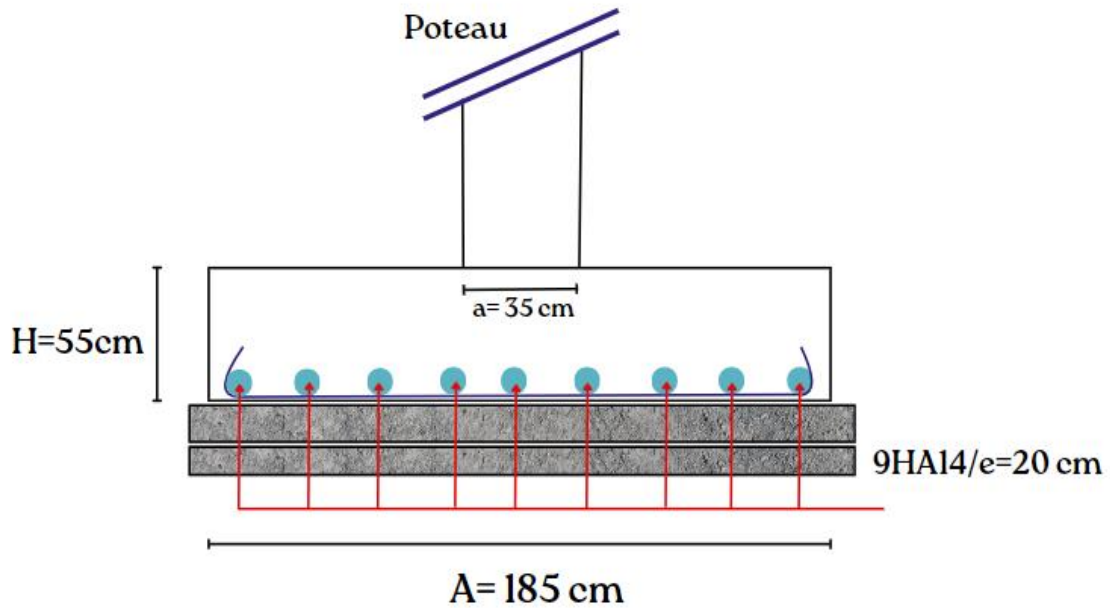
schéma de ferrailage de la semelle en sens A
